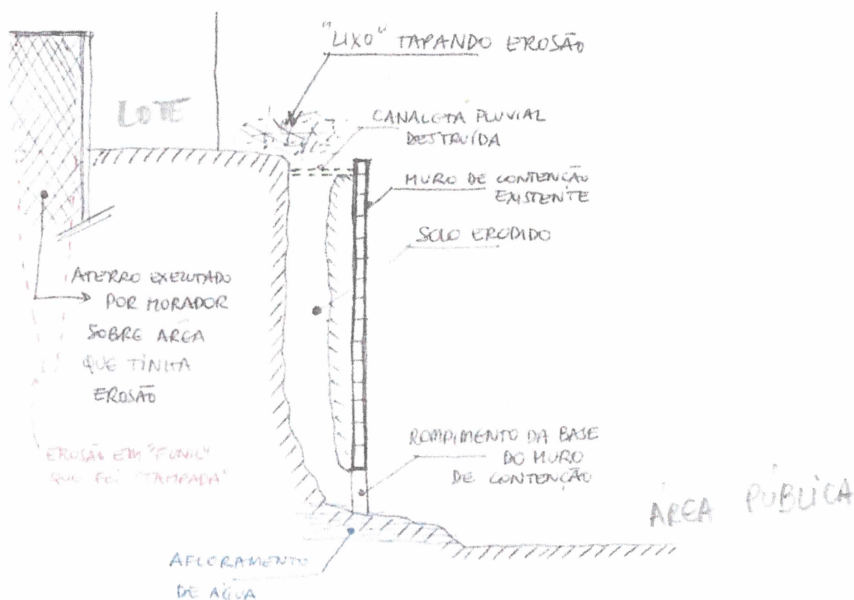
Croqui da situação atual, em corte, na divisa entre as casa de n.16 e n.18.
